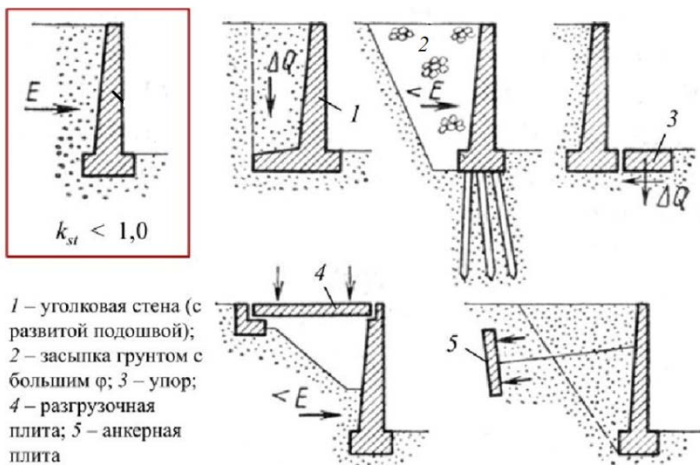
Способы повышения устойчивости тонкостенных бетонных подпорных стен
